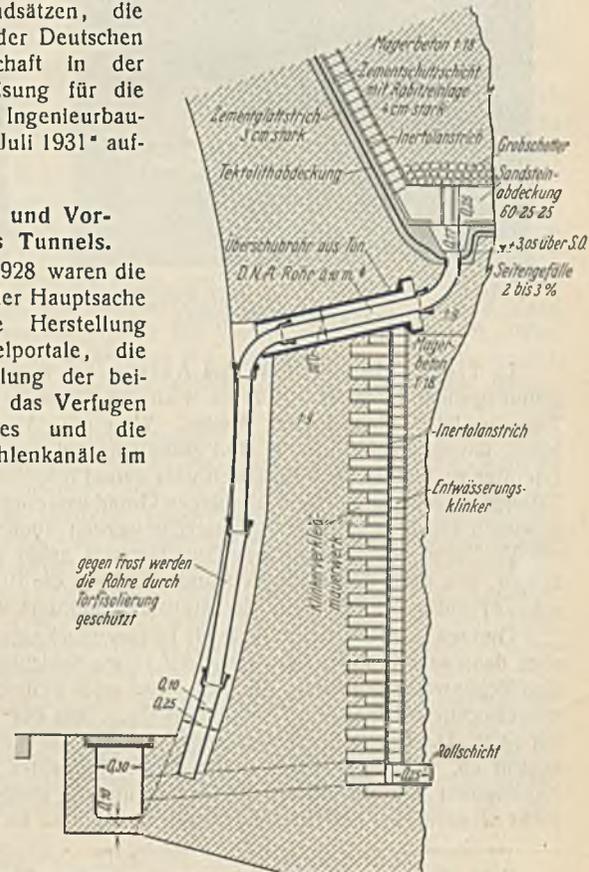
Entwässerung und Abdichtung in den nassen Zonen 46 bis 60.
